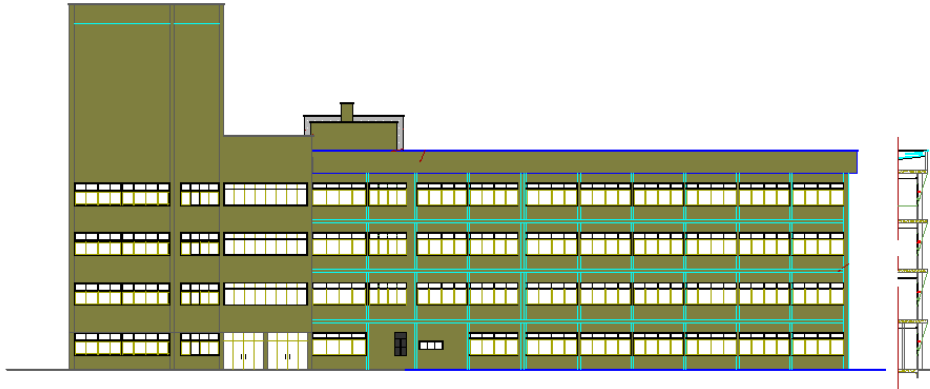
Imagem projeto arquitetônico fachada Sul em *Autocad*.
